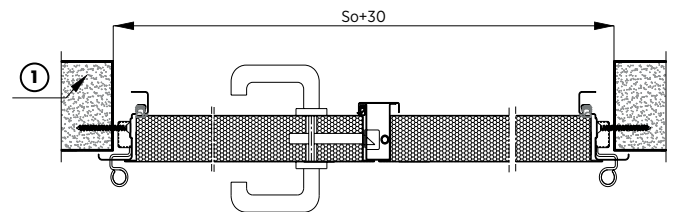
Pose à la construction en acier – bloc-porte à deux vantaux, bâti angulaire sans rupture de pont thermique – coupe horizontale
